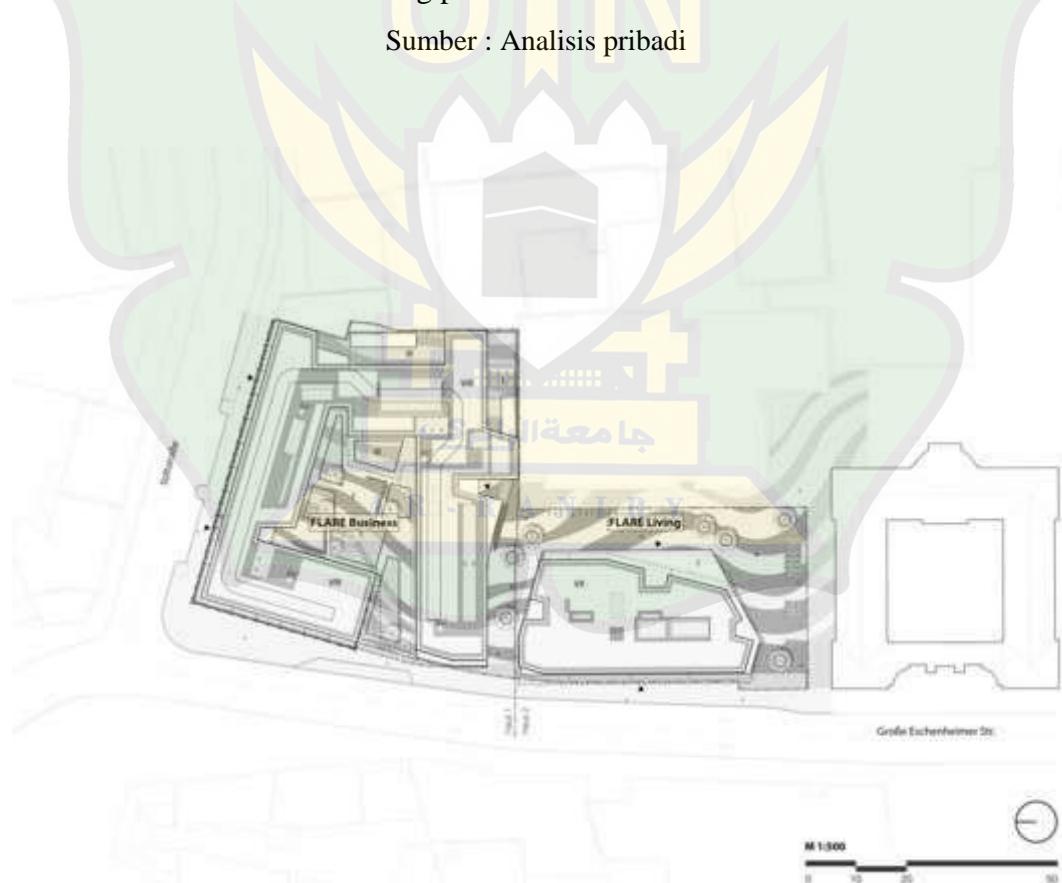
Denah lantai ke enam Flare of Frankfurt
